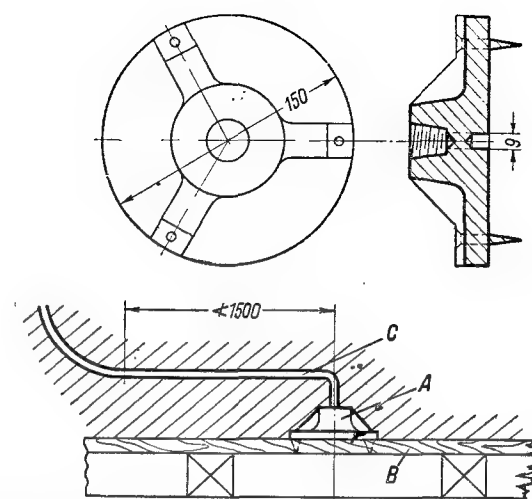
Закладка мерной шайбы в стенку бетонной улитки.
